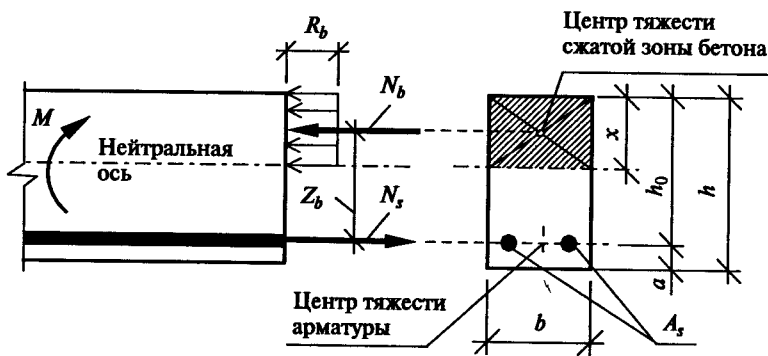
Расчетная схема напряженного состояния поперечного сечения балки с одиночным армированием
